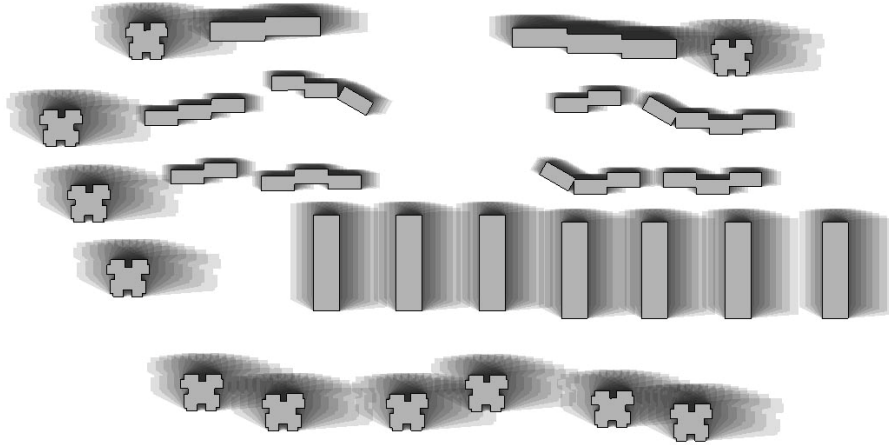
Ataköy 5. Kısım yerleşim planı
